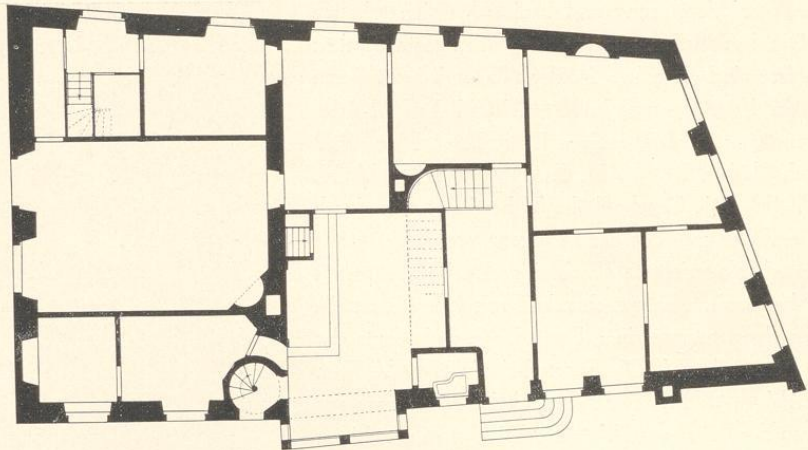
Grundriß des Erdgeschosses des Herrenhauses Alter Steinweg 35
